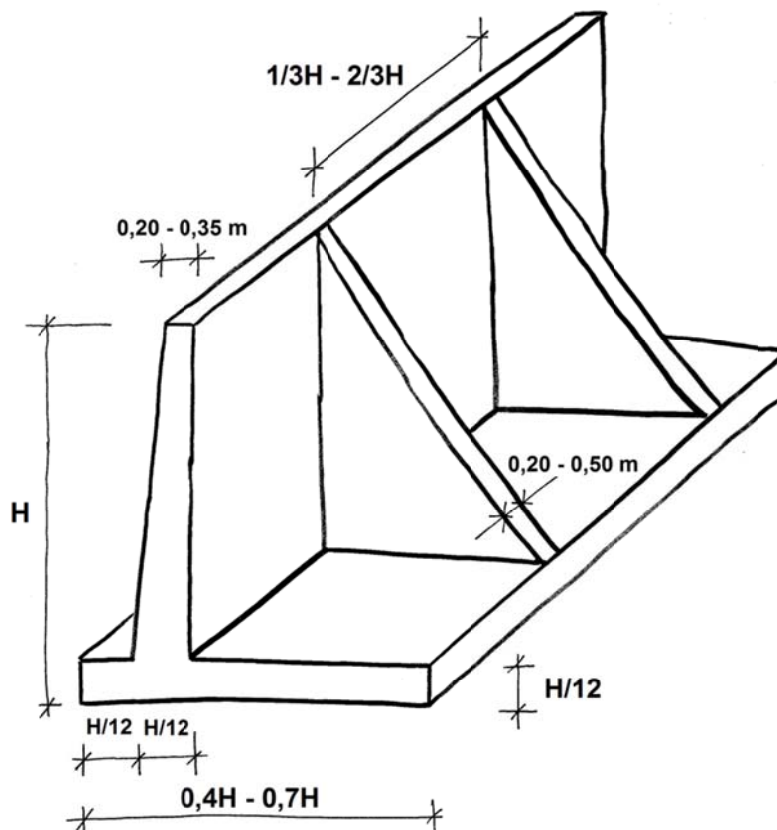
Predimensionamiento habitual en un muro de contrafuertes.
